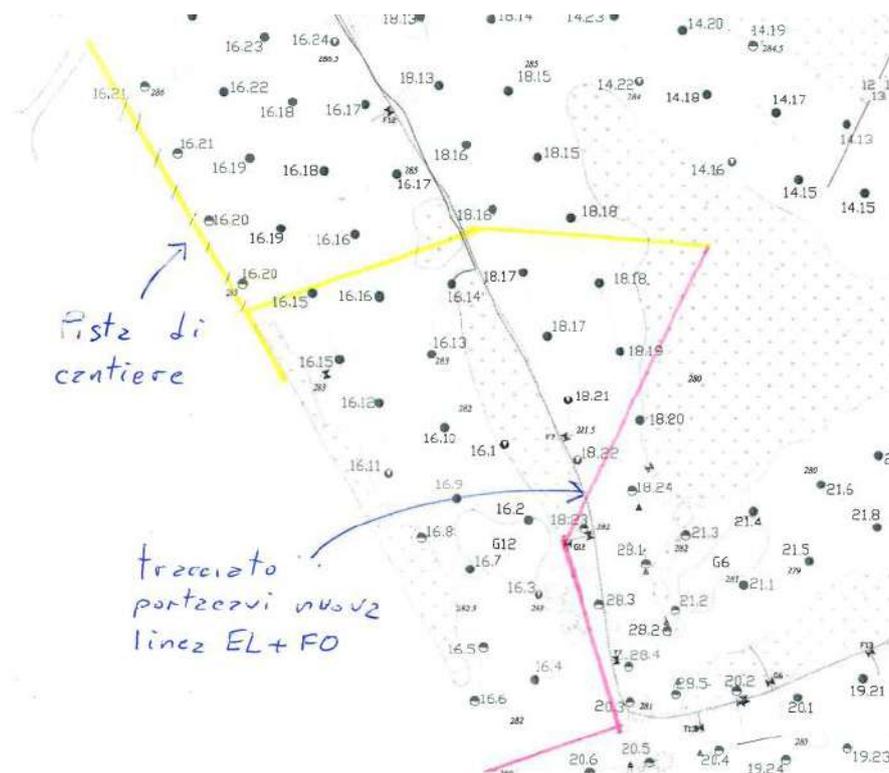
percorso pista di cantiere e portacavi EL - FO estratto
